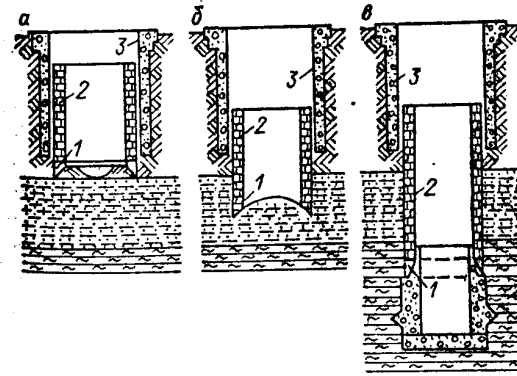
Проходка вертикальной горной выработки в пьлувах с помощью опускной крепи.
